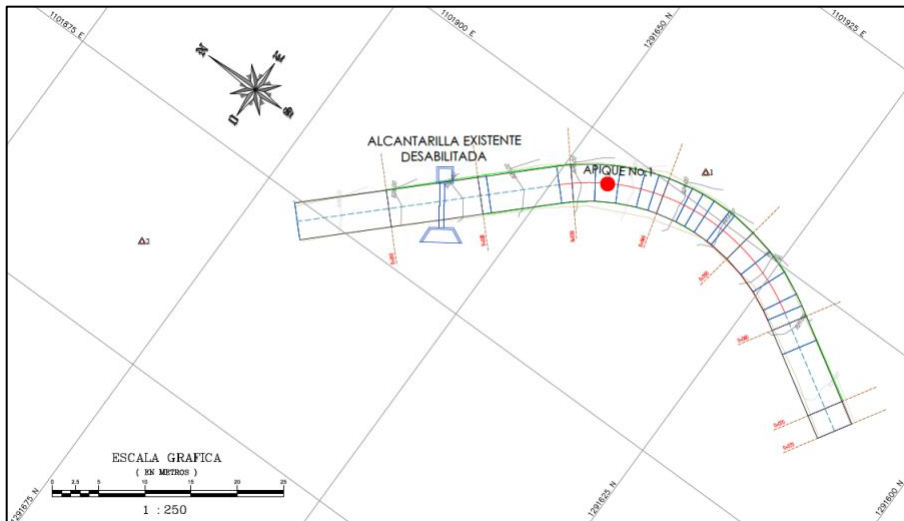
Imagen de planta del tramo 5 del proyecto de Rionegro-Santander
